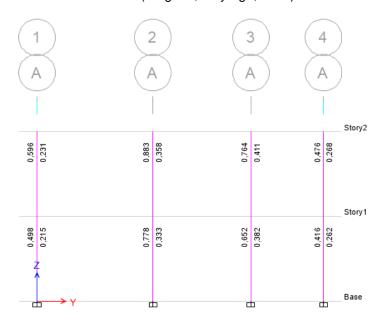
Criterio Columna fuerte Viga débil ETABS (6/5).
